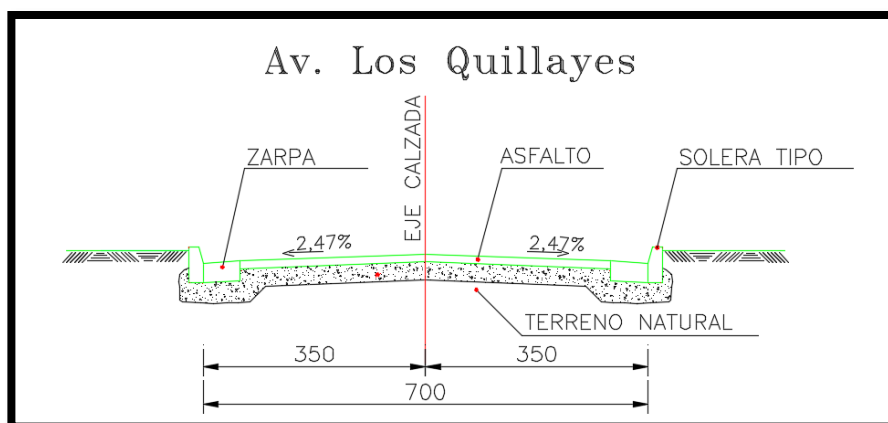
Perfil Transversal Calle Los Quillayes
